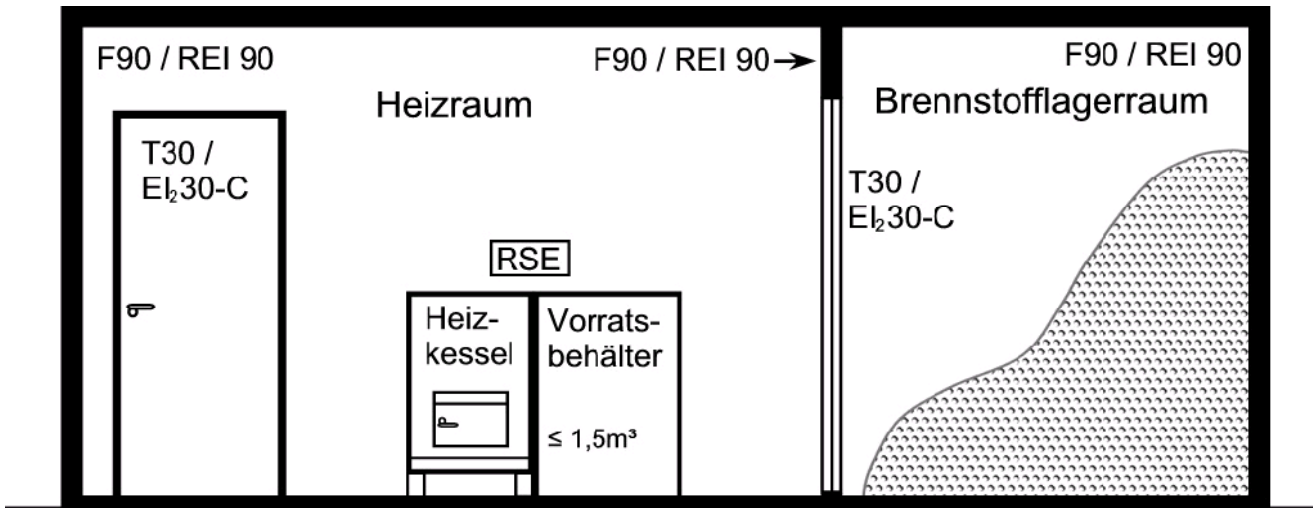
Kompaktanlage im Heizraum (5.1.3) mit anschließendem Brennstofflager (5.1.3), Heizleistung ≤ 150 kW, Brennstoff gemäß Punkt 3.3 (sonstige Holzreste)
